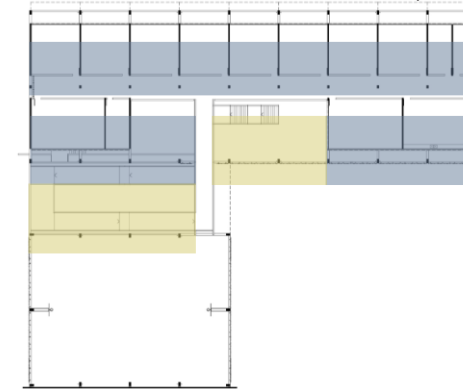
Planta Baixa Segundo Pavimento - Fonte: Archdaily
